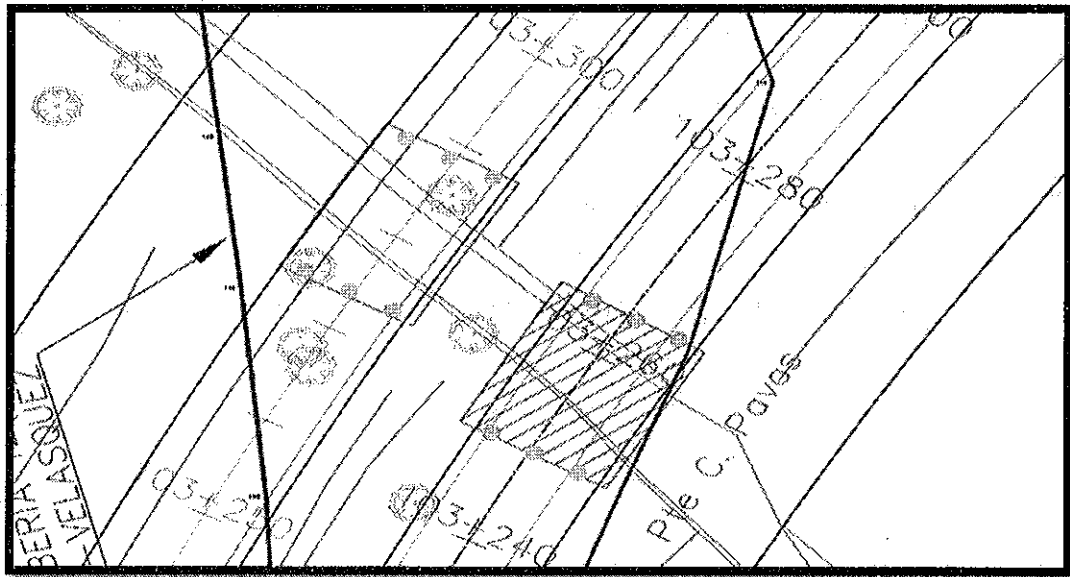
acercamientos críticos con estructuras viales (Puentes) e infraestructura petrolera
